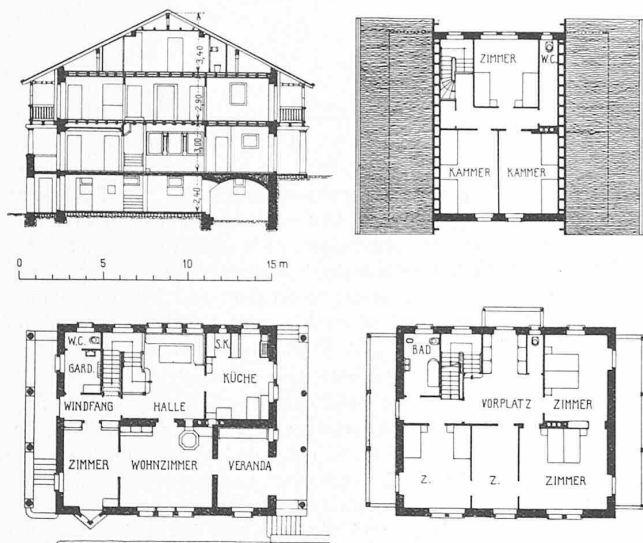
bis 4. Haus Dr. Misslin in Flims. Grundrisse und Schnitt 1 : 400.
